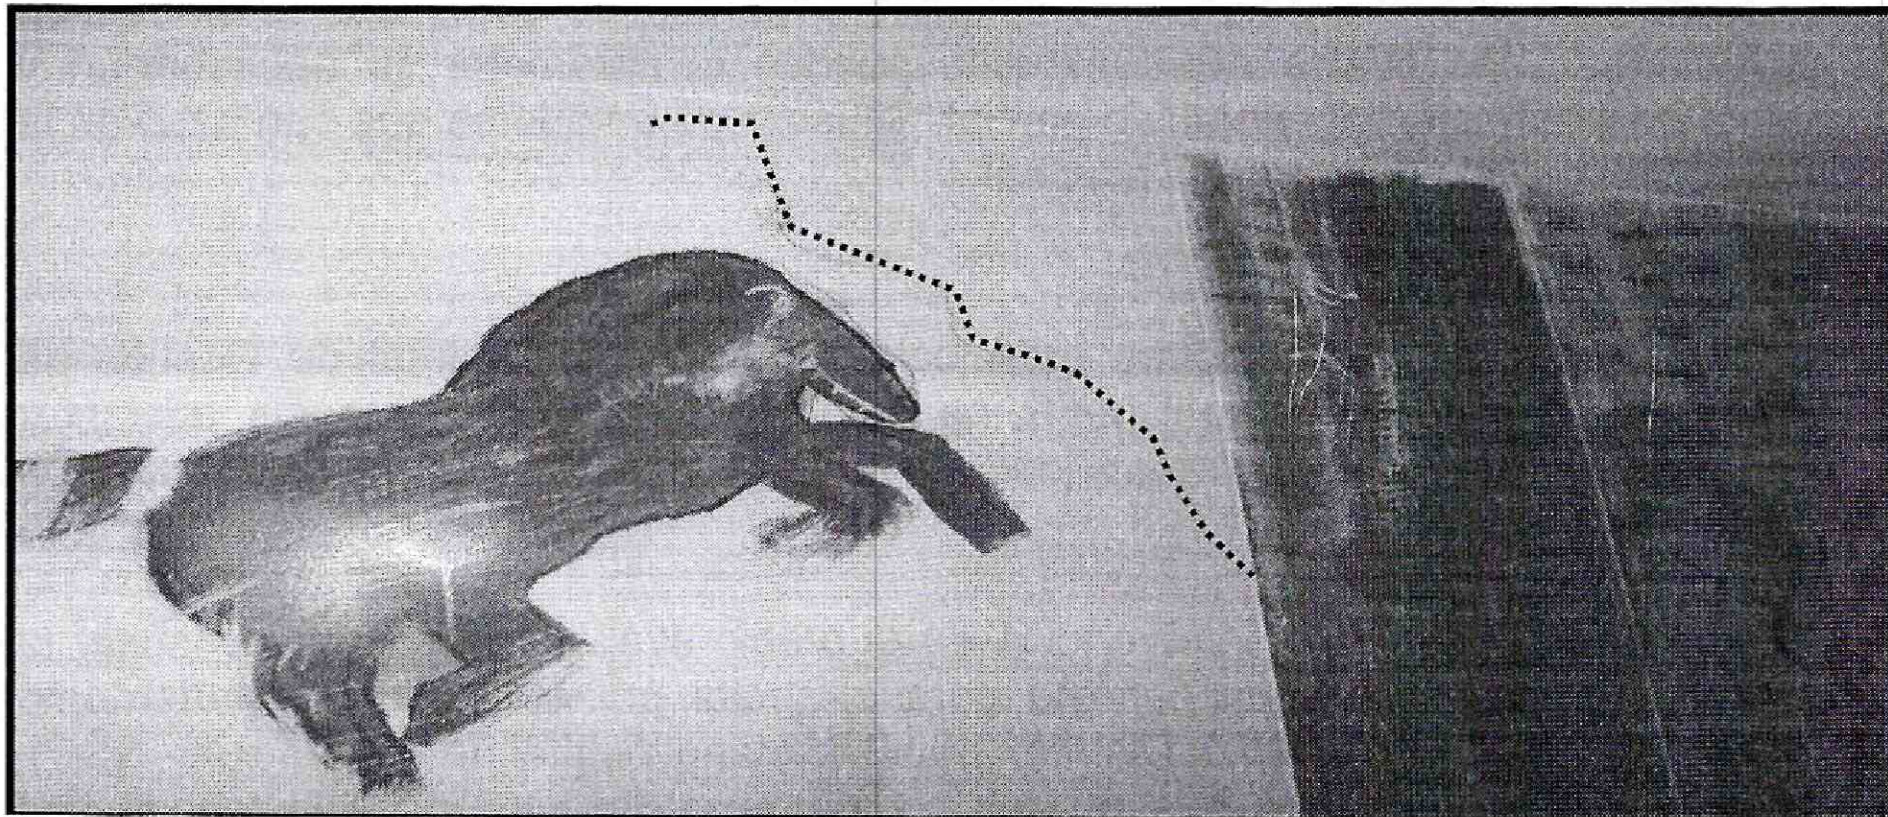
Fisuras de tendencia horizontal con abertura menor al milímetro en el acabado de unos de los muros de la cocina.
